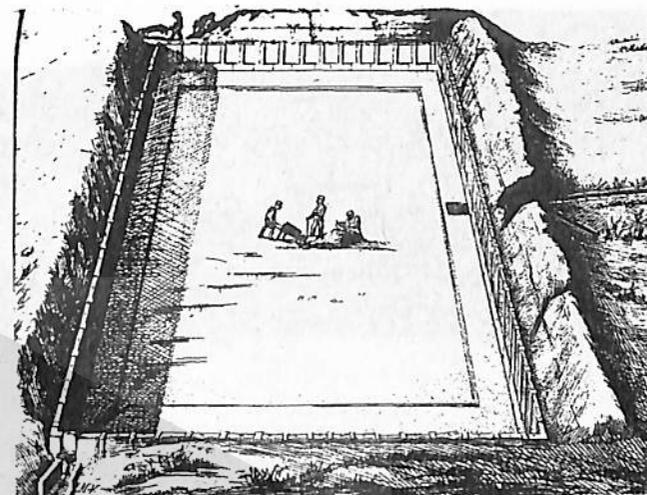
Bassin de Kasrou, vue d'ensemble par Moliner-Violle.
